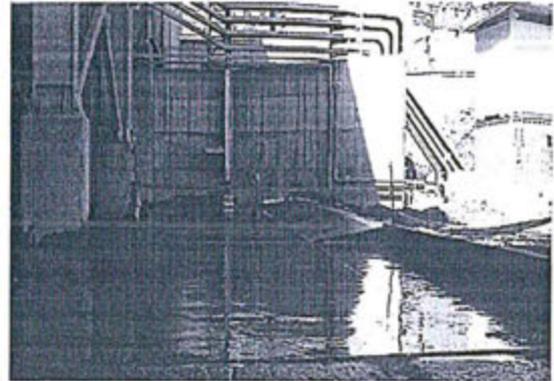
Vaciado de concreto sobre la losa y vista del acabado
